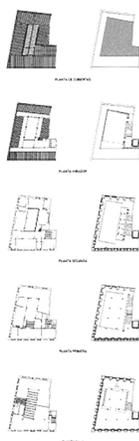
Planta baixa do Centro José Gerrero¹⁸
